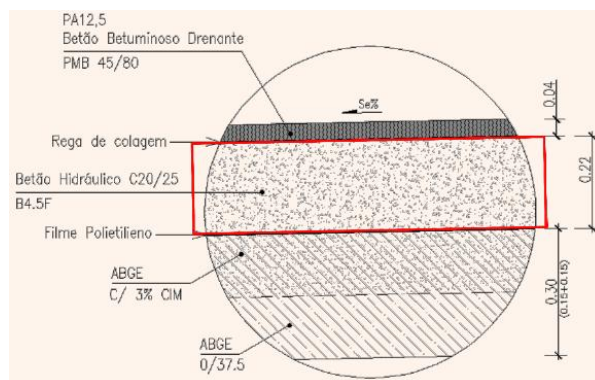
Constituição de um Pavimento Smi-rigido (Fonte: Jacob, 2013)
